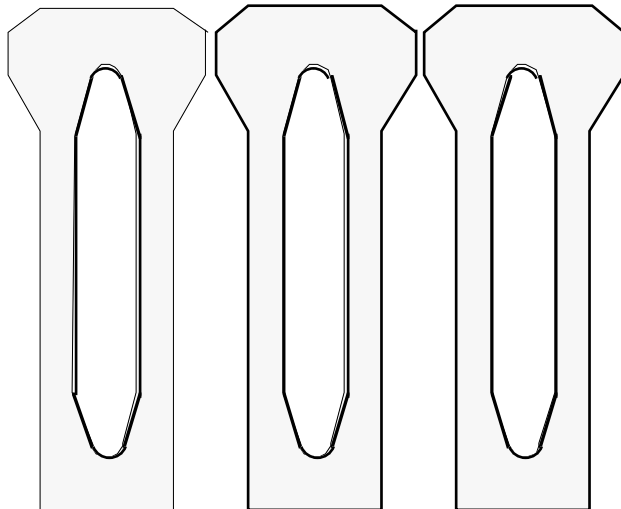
Diga a gravità alleggerita tipo Marcello, Sezione e Pianta altezza 51 [m], pianta 54.75[m]
